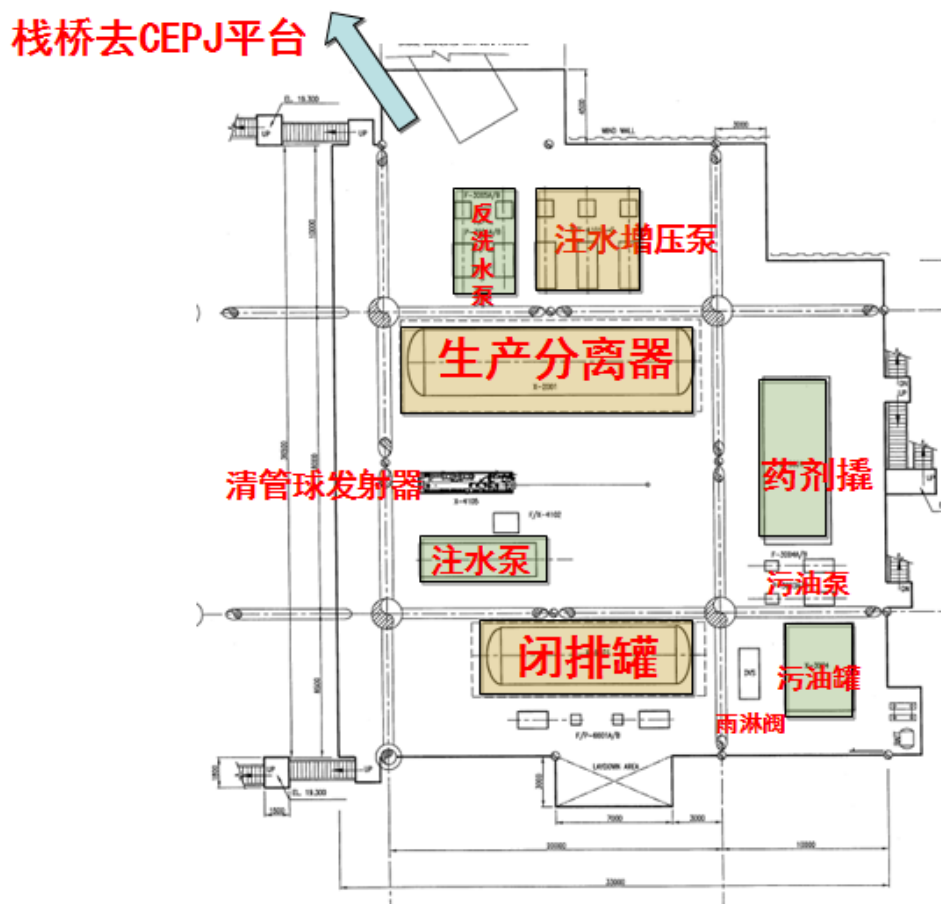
QHD32-6CEPL 平台下层甲板平面布置图
